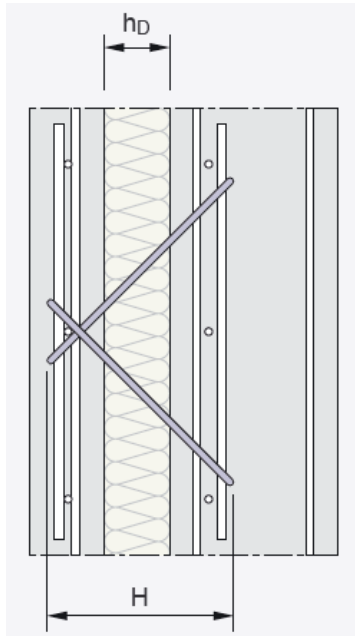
Bijlegwapening draagankers SPA1/SPA2
